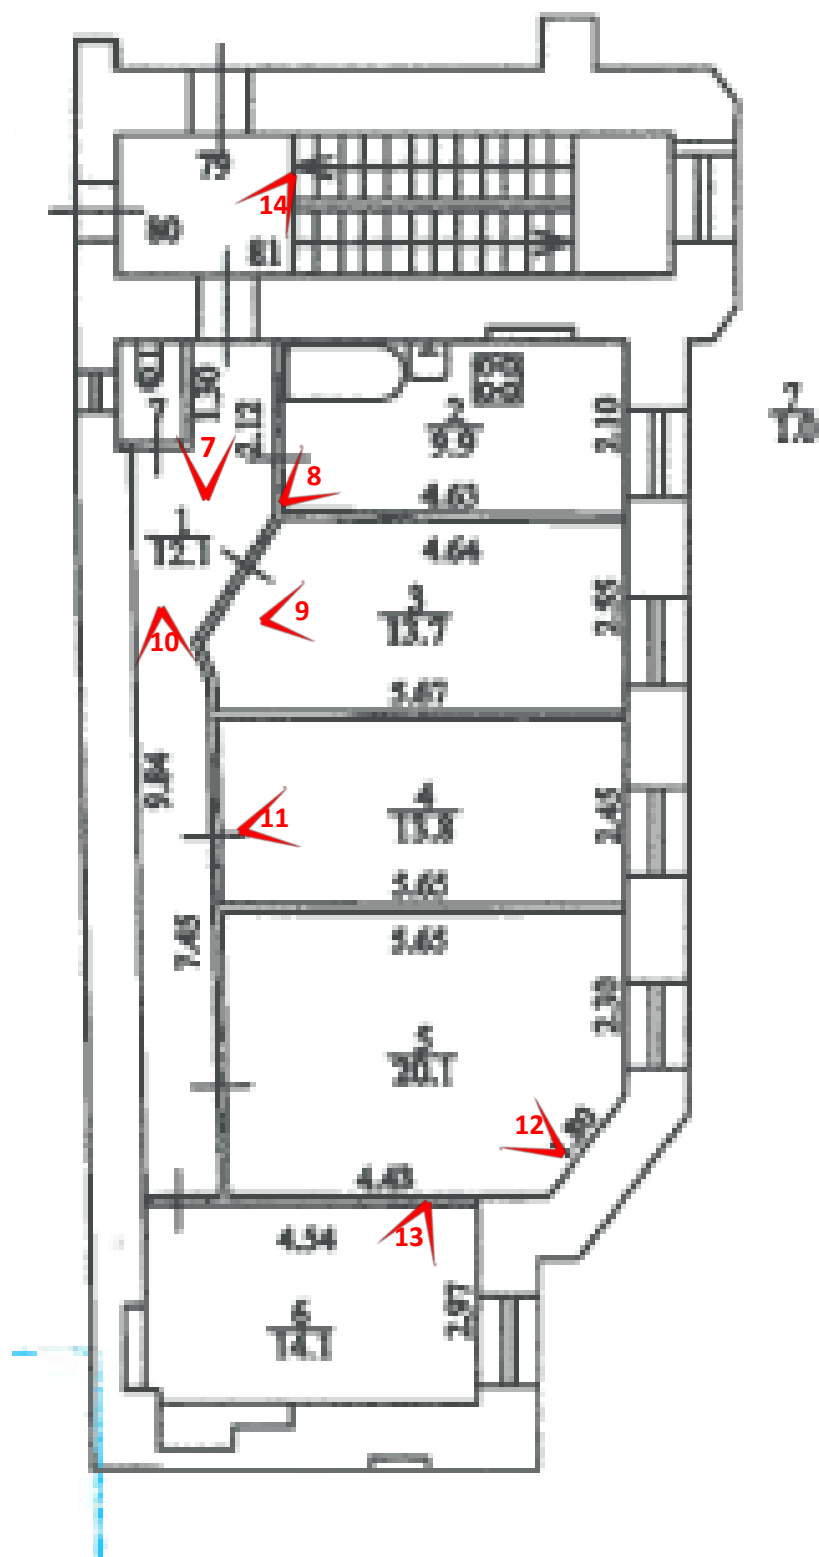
Схема фотофиксации на фрагменте плана 4 этажа
